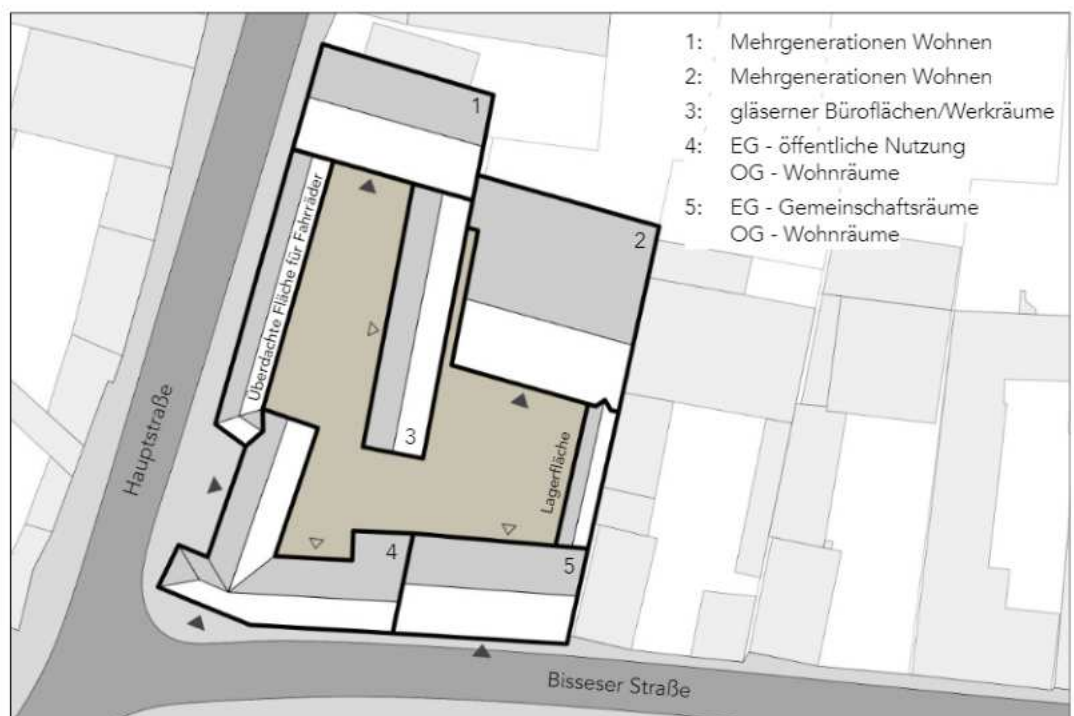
Beispiel-Liegenschaft mit Sanierungsbedarf - Hauptstraße 123 und Bisseseer Straße 2
